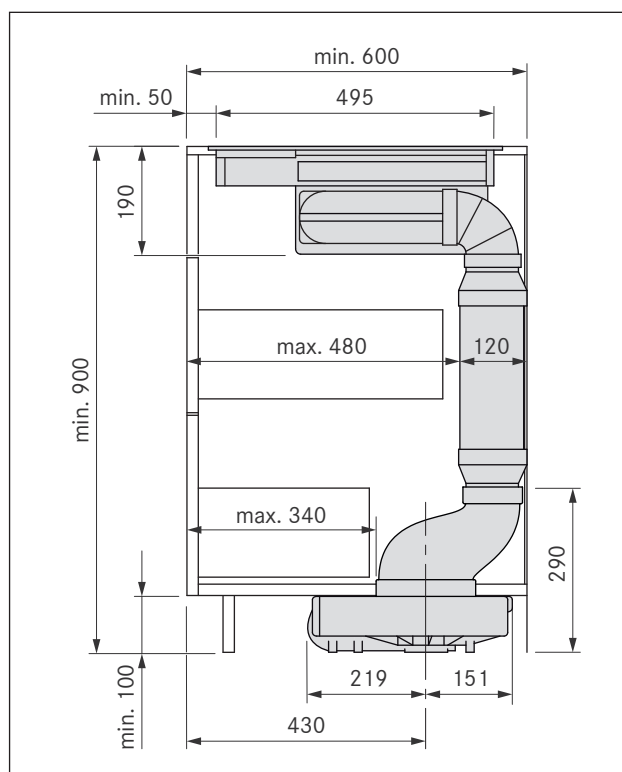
Dimensões de montagem do aparelho com silenciador plano USDF num armário com 600 mm de profundidade
